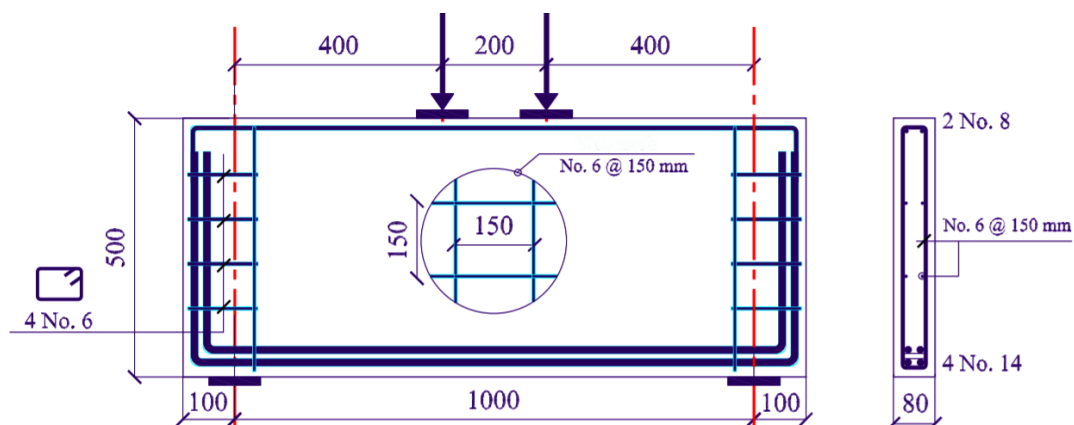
Detalhes armaduras das vigas-parede, dimensões em mm (EL-MAADDAWY e SHERIF, 2009).
